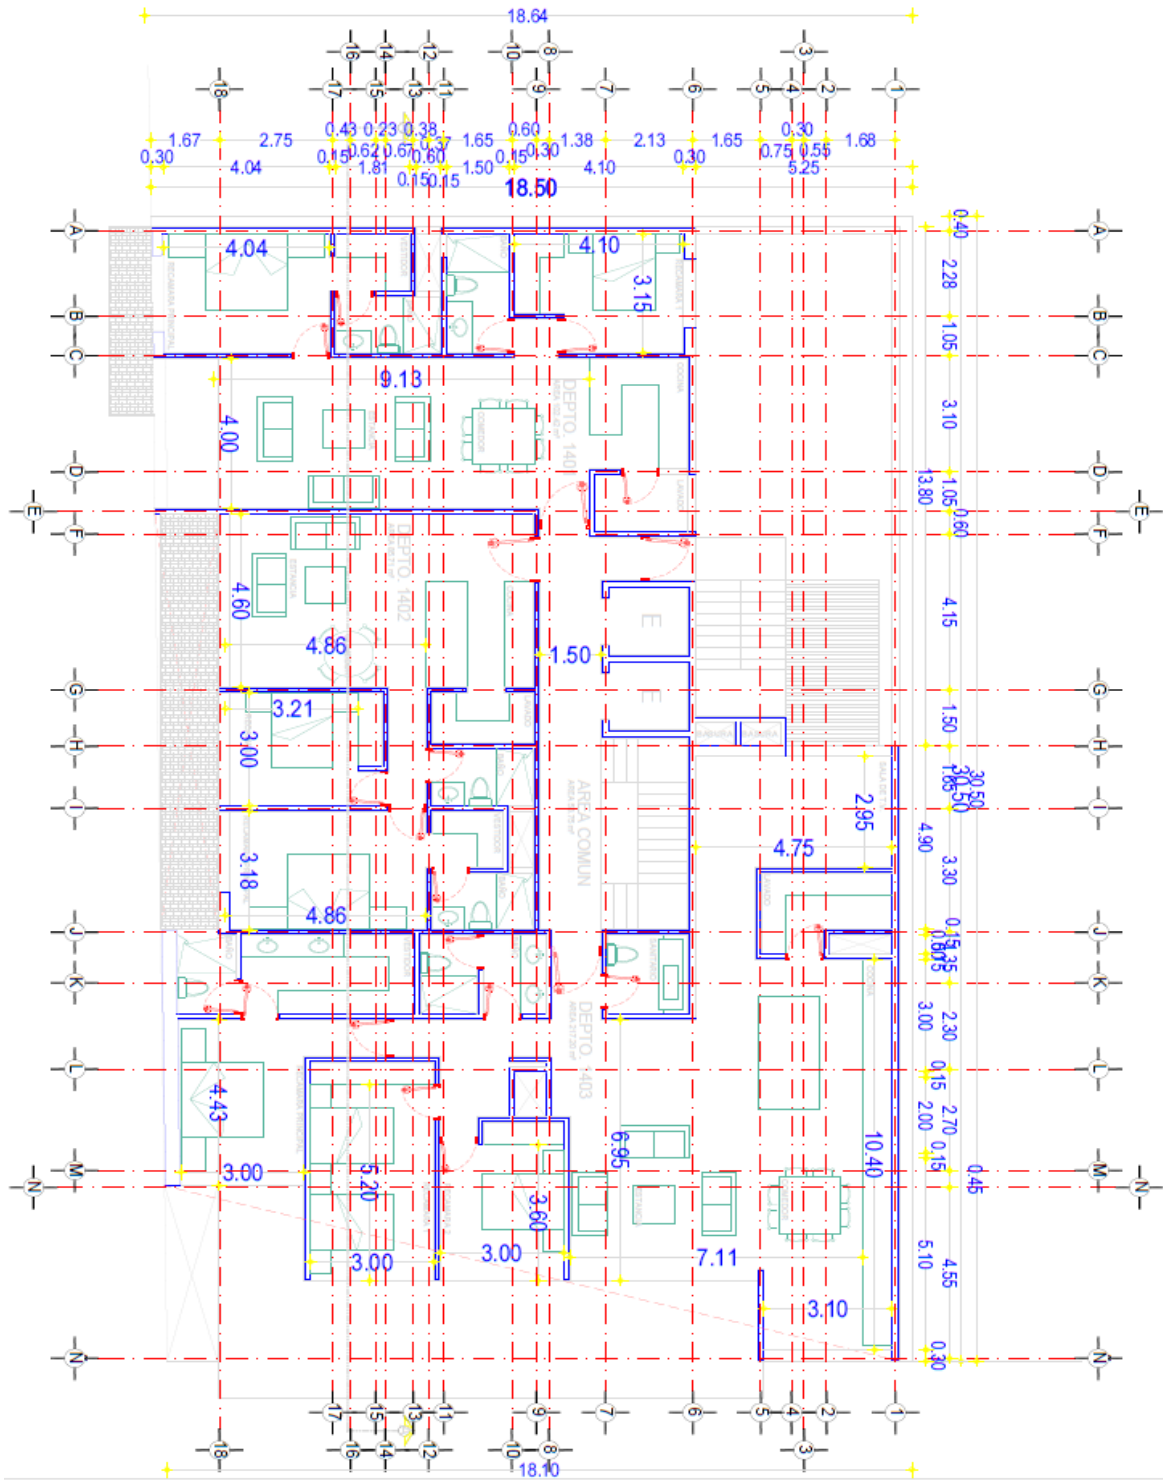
E.- PLANTA ARQUITECTÓNICA NIVEL 14
